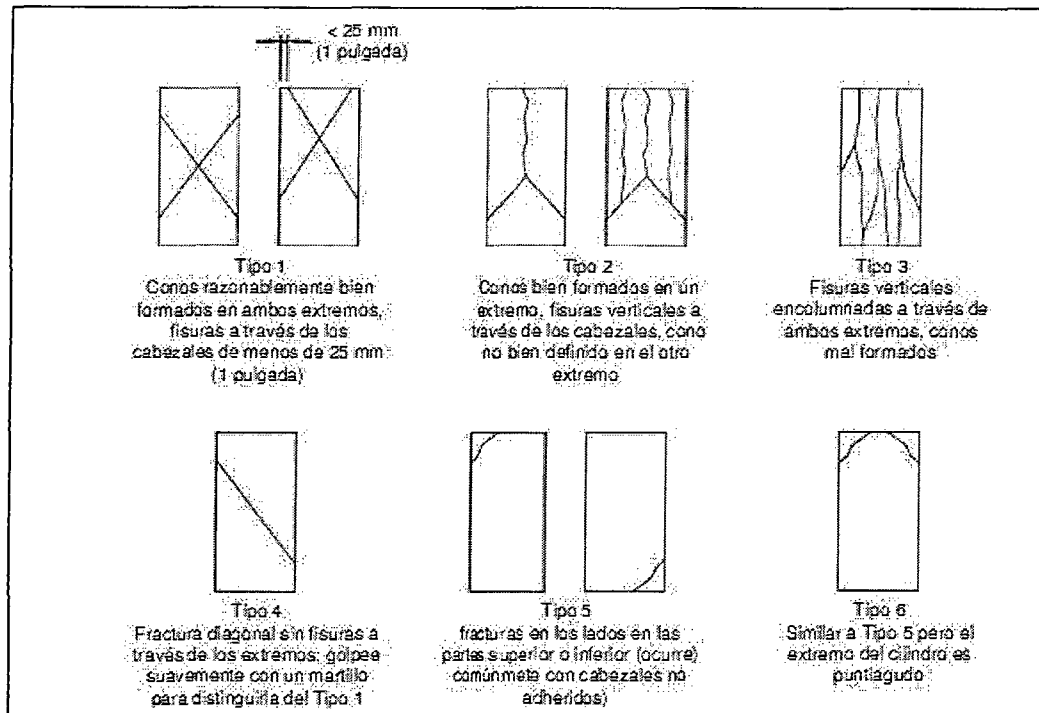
Tipos de fractura típicos que se dan en la rotura de probetas cilíndricas ensayadas a la compresión.
